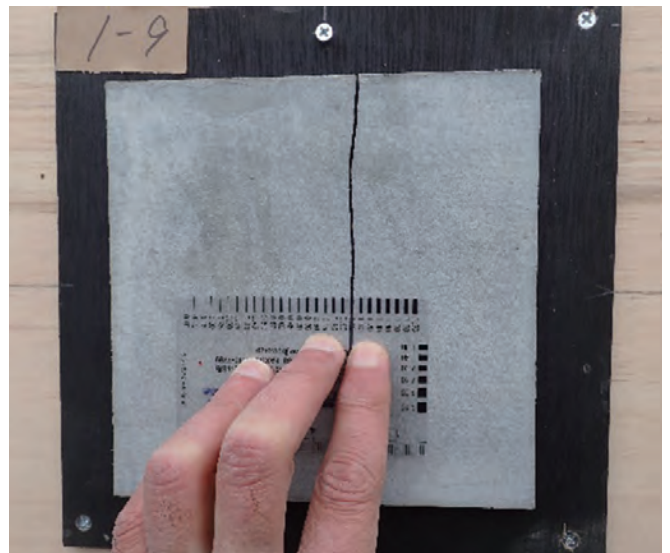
ひびわれ模擬供試体 (ひびわれ幅1.0mm)
